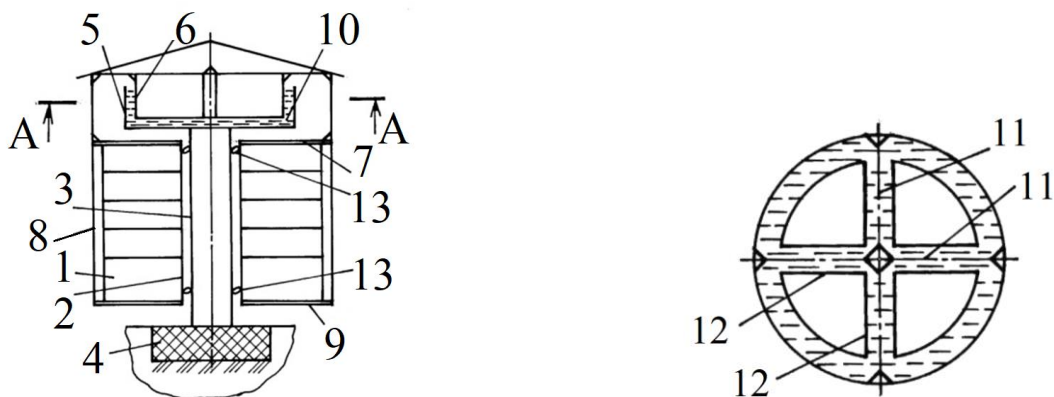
Сейсмостойкая конструкция здания: 1 – блок этажей; 2 – шахта; 3 – стойка; 4 – фундамент; 5 – чаша; 6 – ёмкость; 7, 9 –плита перекрытия; 8 – тяги; 10 – вода; 11, 12 – рёбра жёсткости; 13 – амортизаторы
